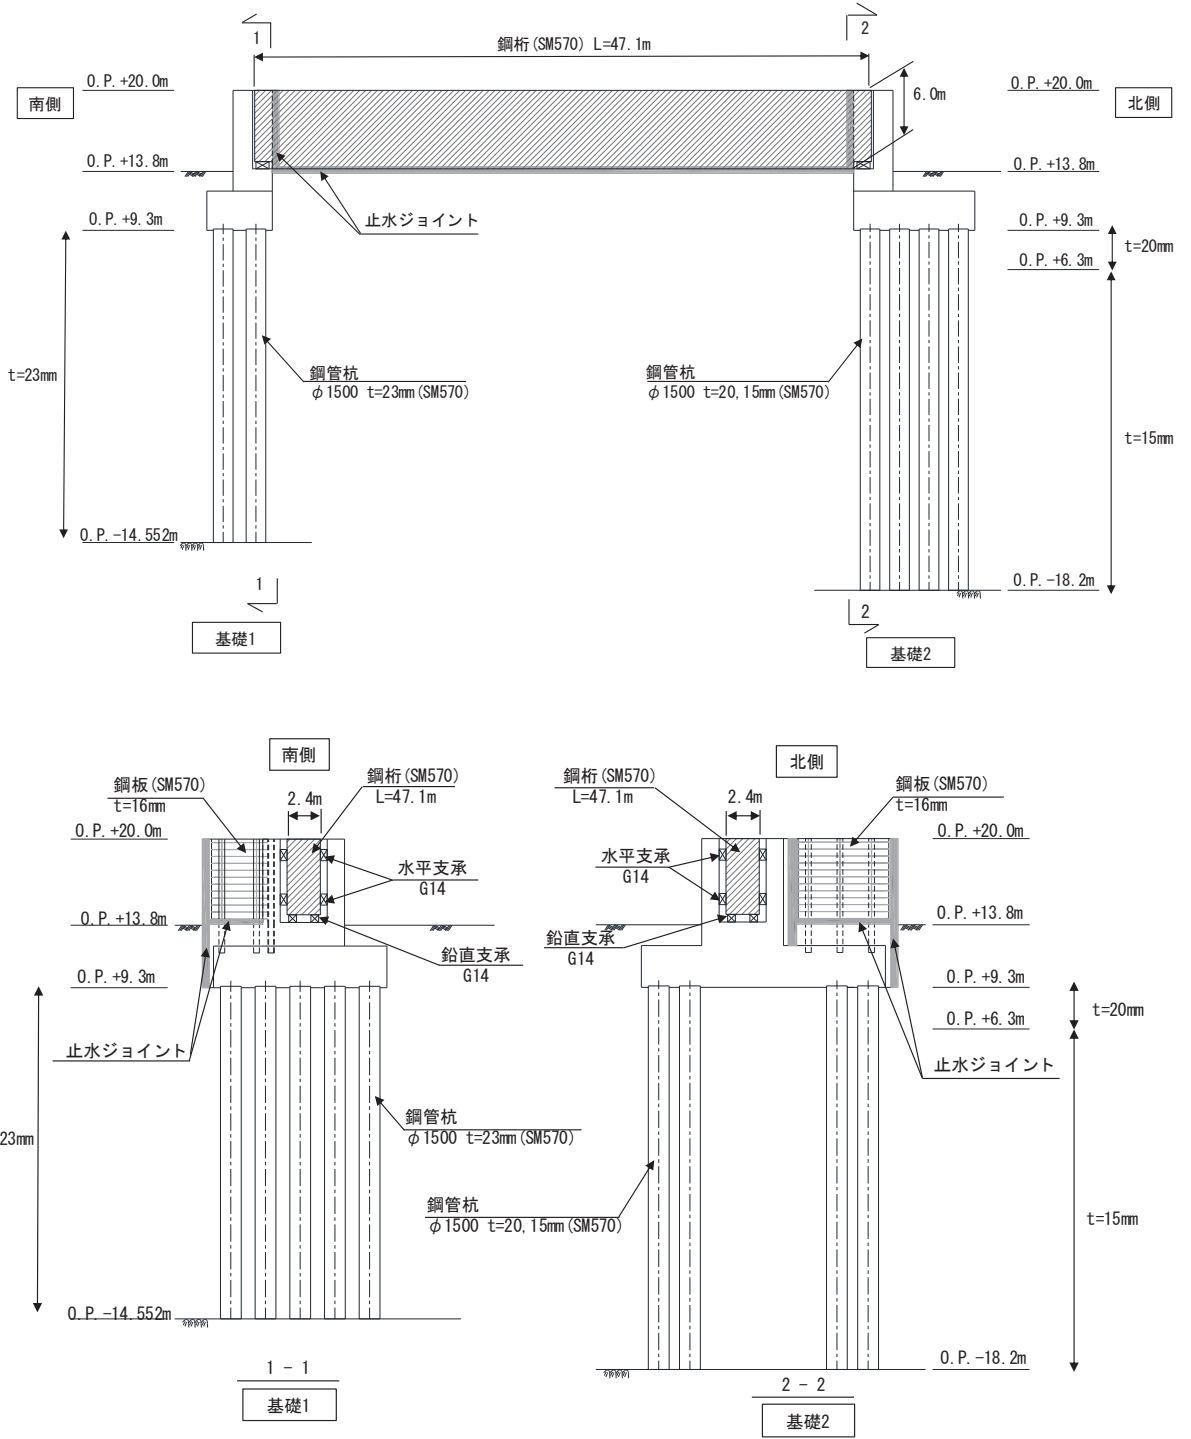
鋼製遮水壁 (鋼桁 4) 正面図及び断面図
